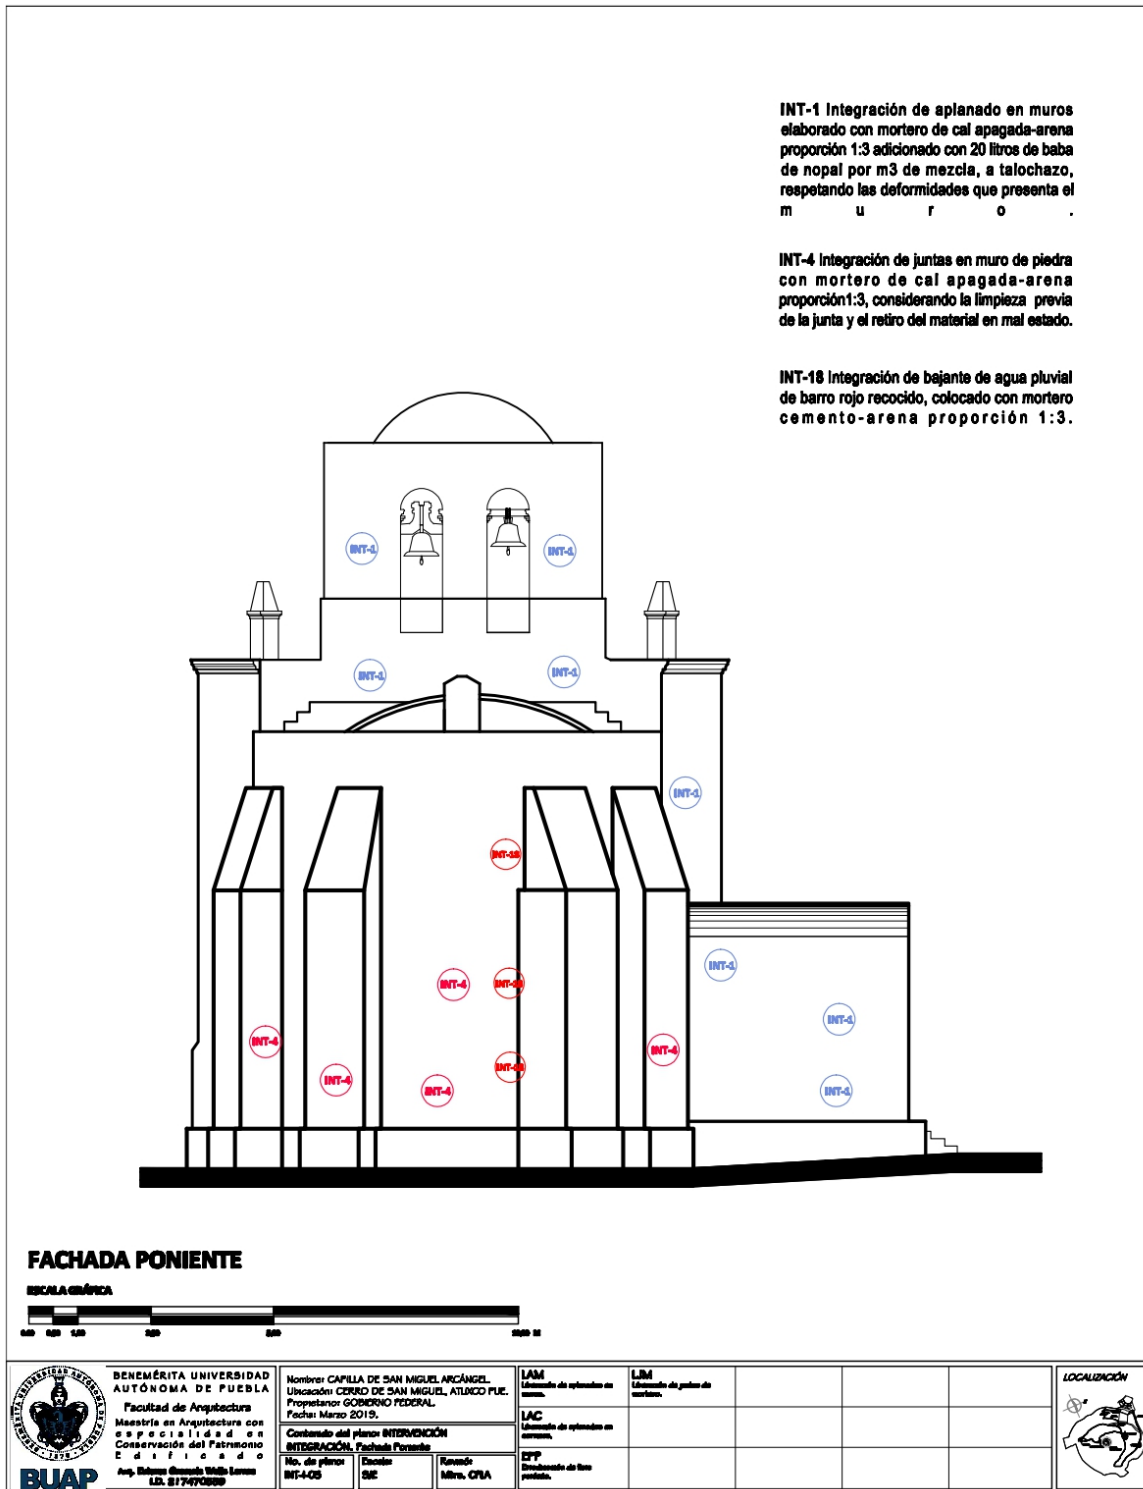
Plano 6 de integraciones en fachada poniente (posterior).
